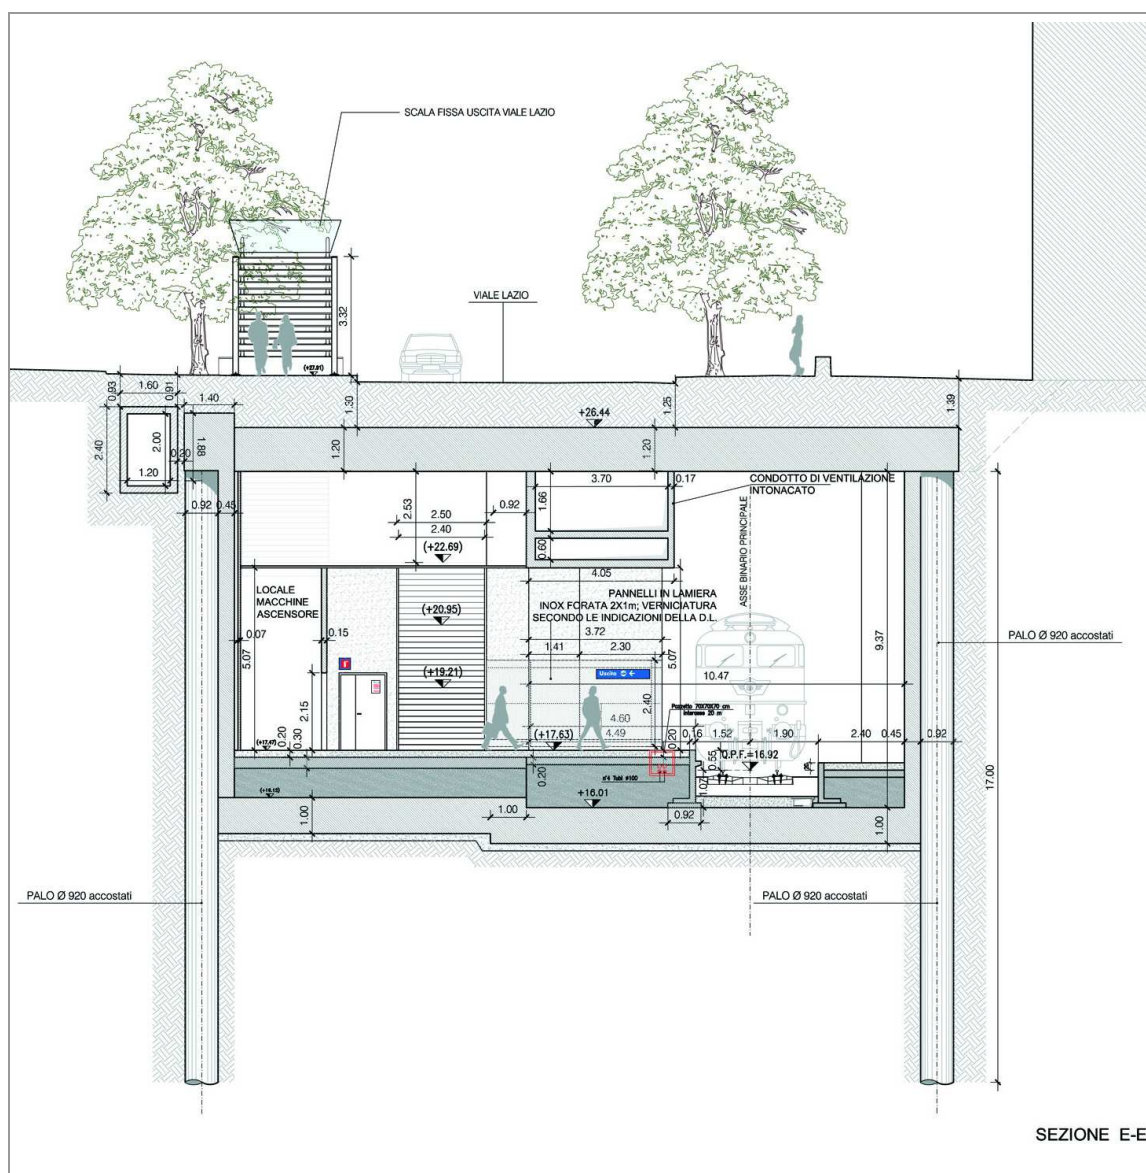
Sezione trasversale della galleria artificiale in corrispondenza dell'accesso banchina
